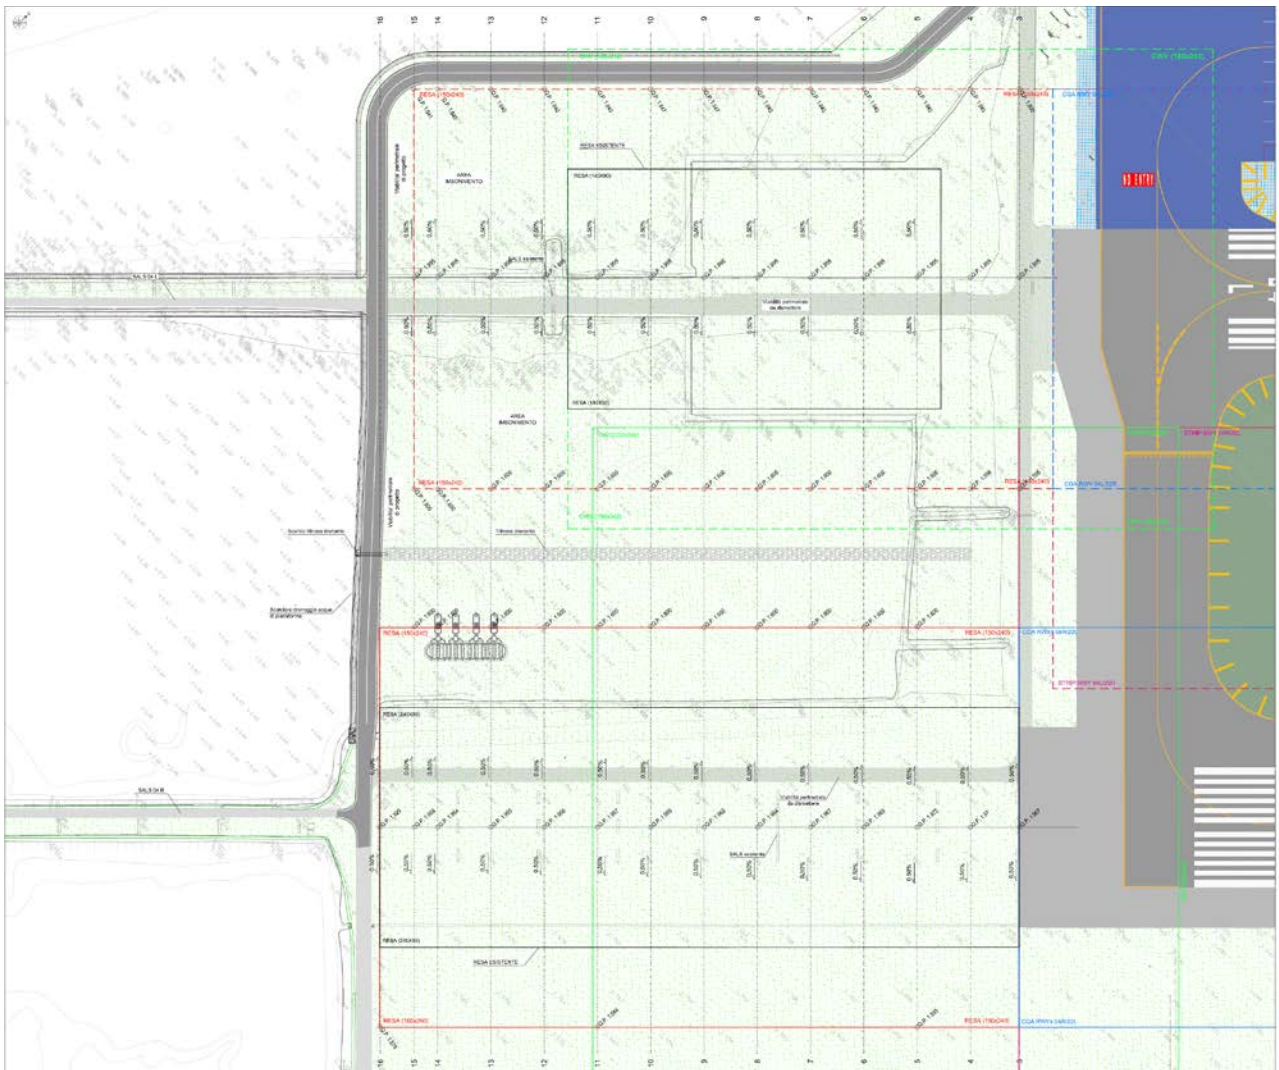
Inquadramento planimetrico intervento di adeguamento dell'area di RESA in testata 04L.
